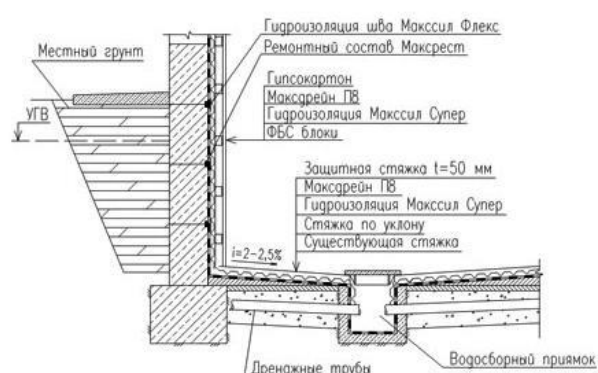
Схемы и способы гидроизоляции подвального помещения
